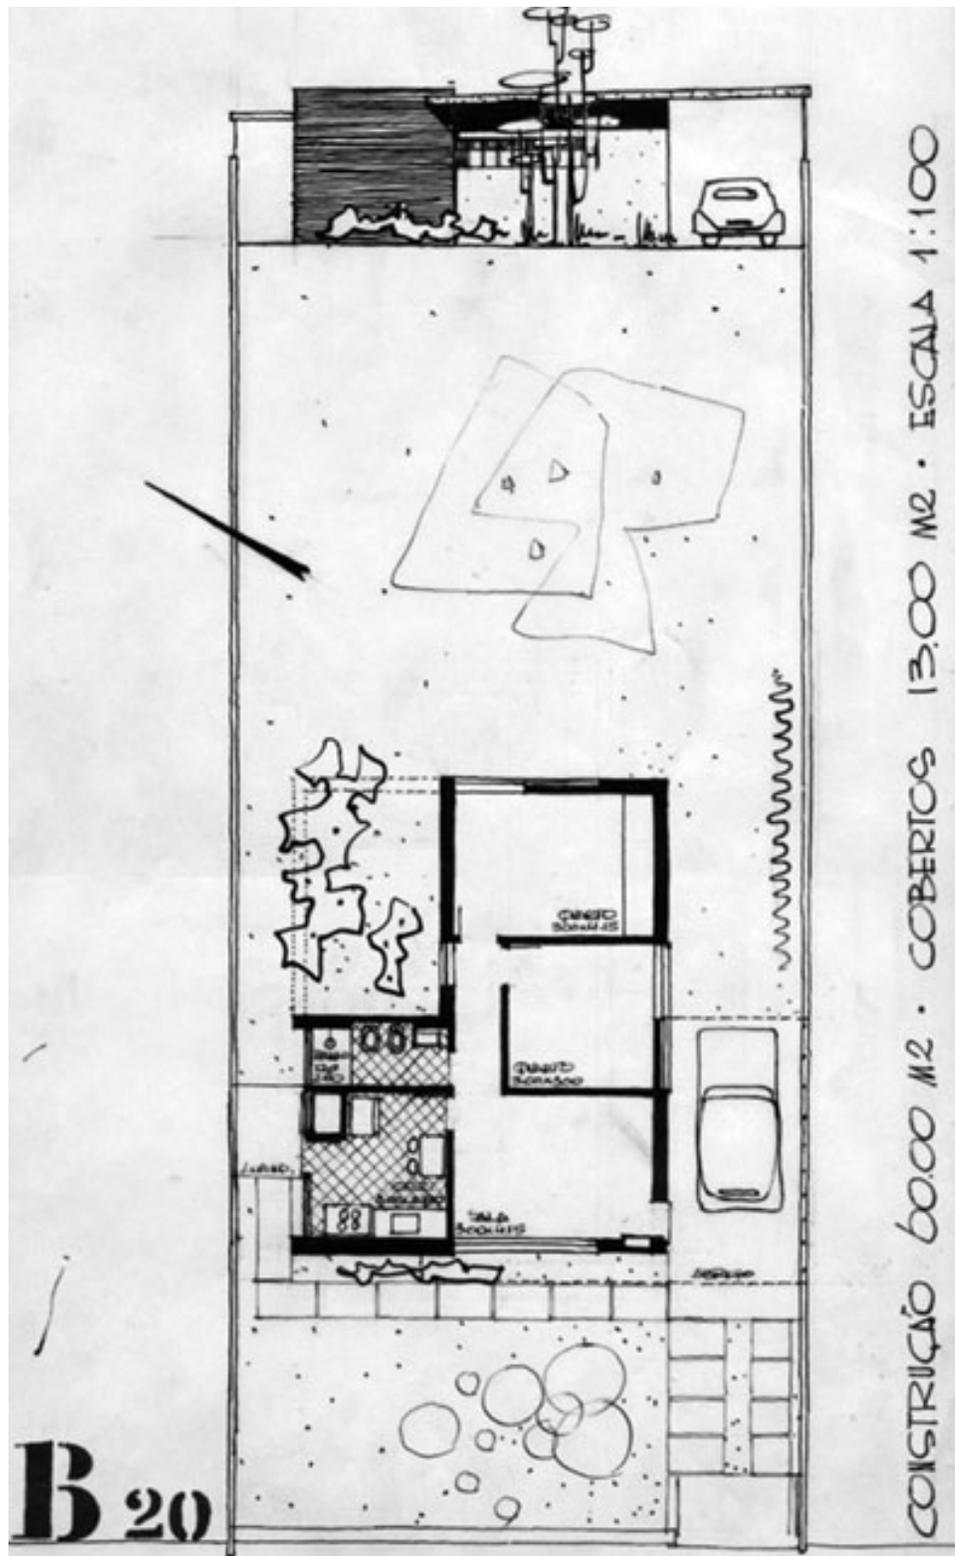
Resolução para residência de tamanho mais reduzido. Planta e fachada.
